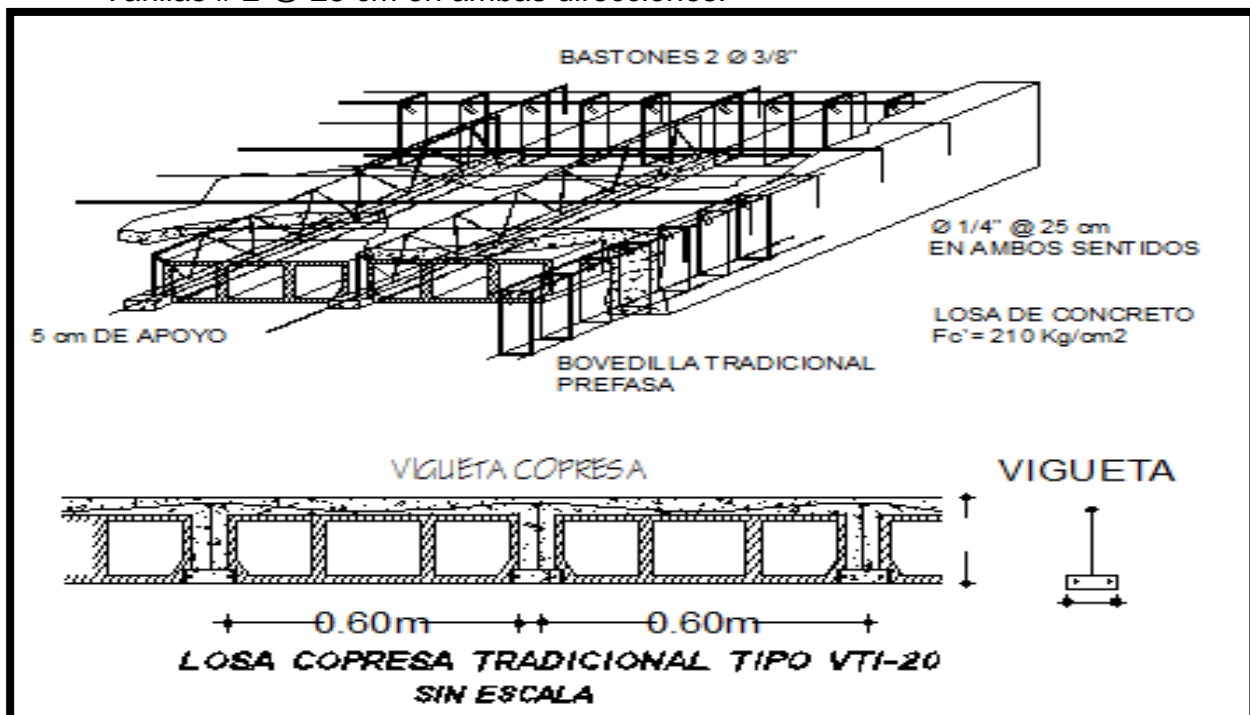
Modelo de losa aligerada con distribución de refuerzo y secciones.
